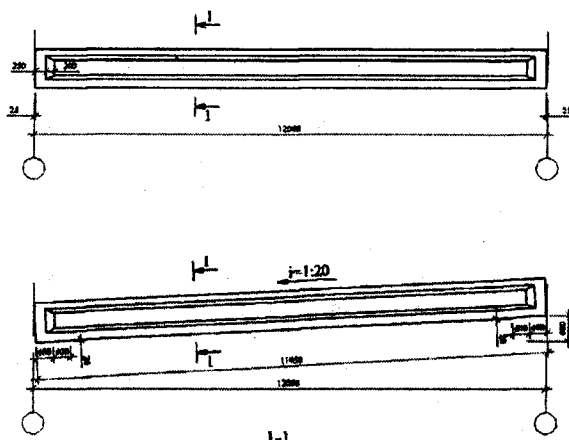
Балки плоских и малоуклонных покрытий пролетом 12 м
